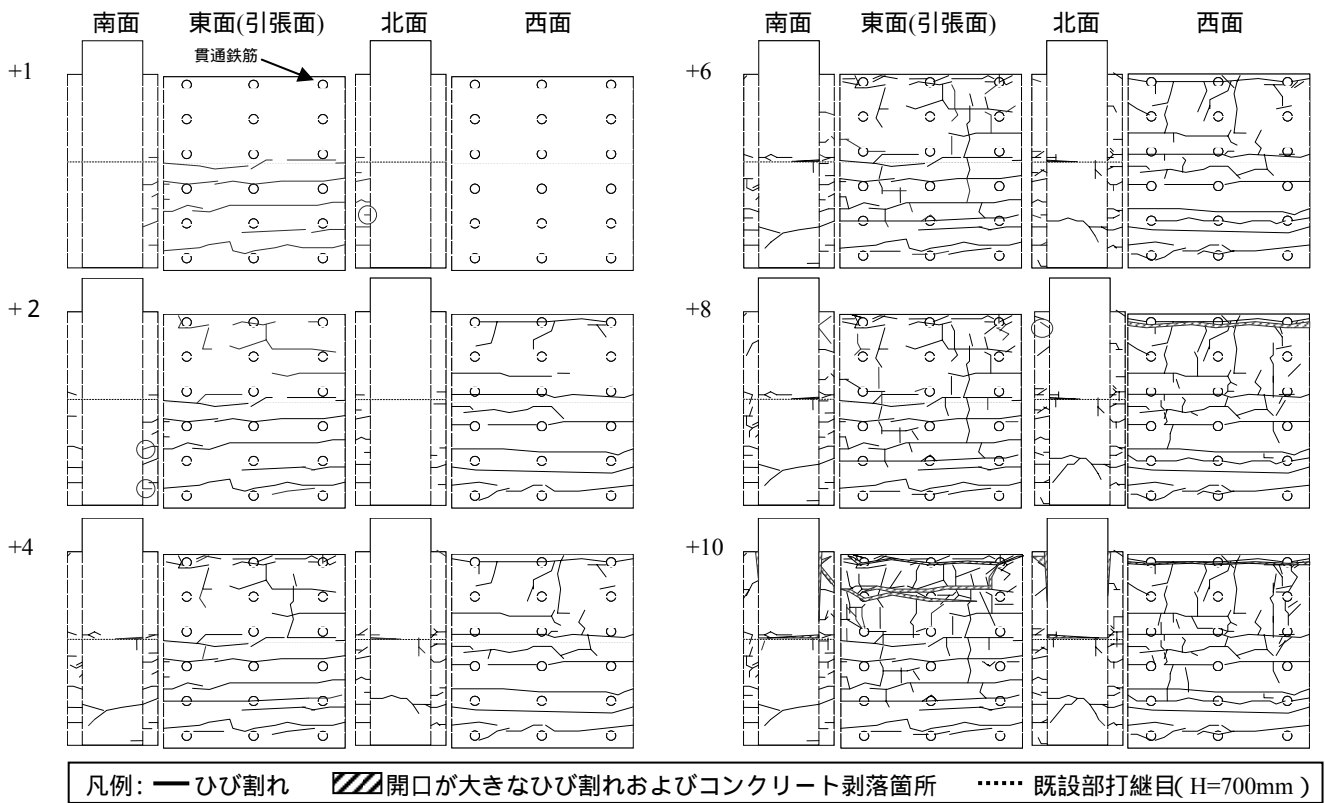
試験体表面ひび割れ発生図 (RC-S-11)
